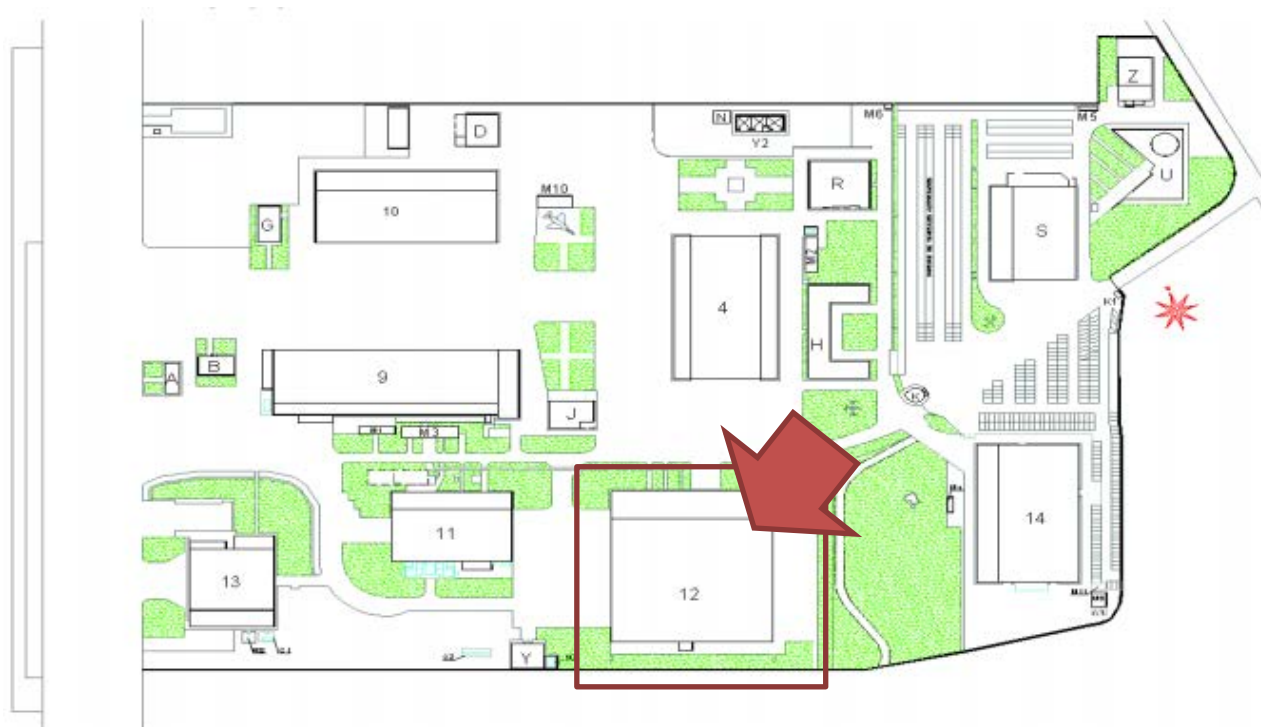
Plano distribución planta MRO SPN (Fuente: MRO SPN)
